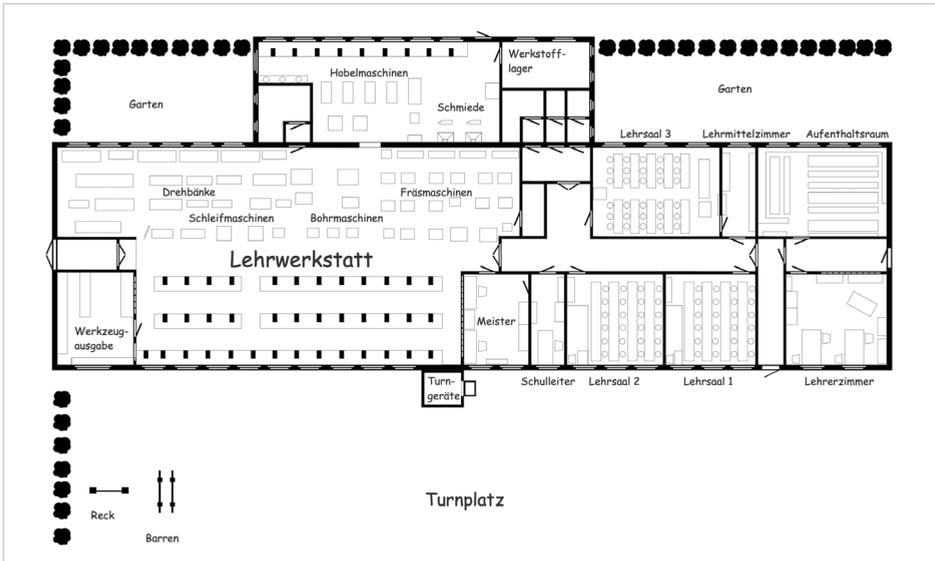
Grundriss einer betrieblichen Werkschule und Lehrwerkstatt (Dehen 1928, S. 178)
